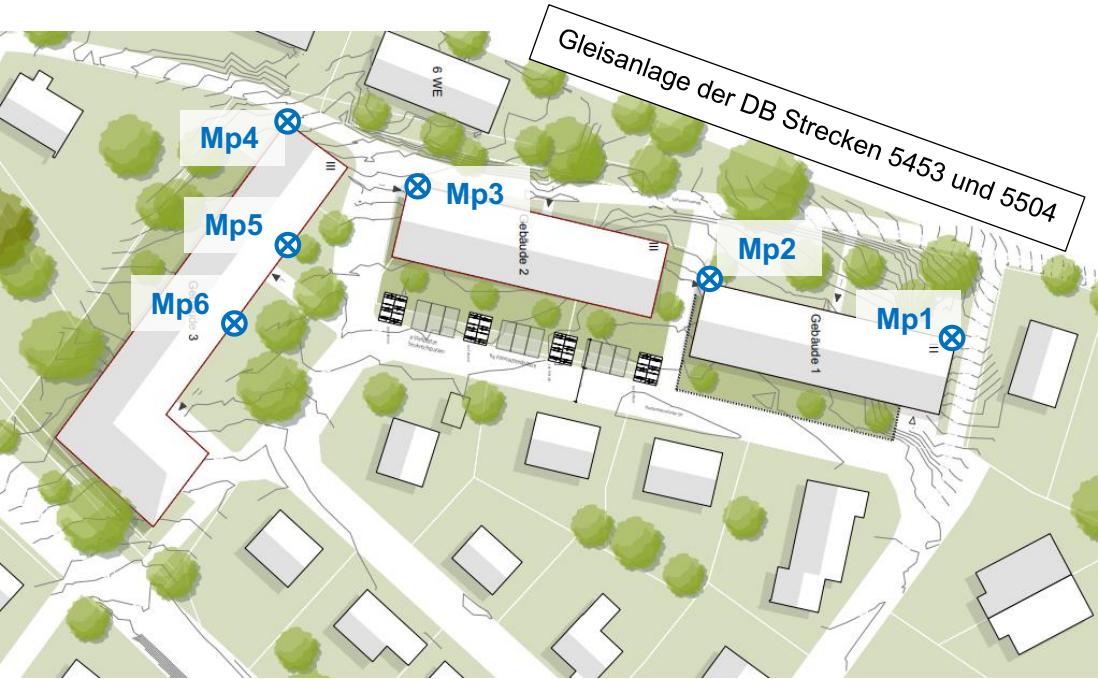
Plangebiet mit Lage der Messpunkte. Prinzipskizze.
